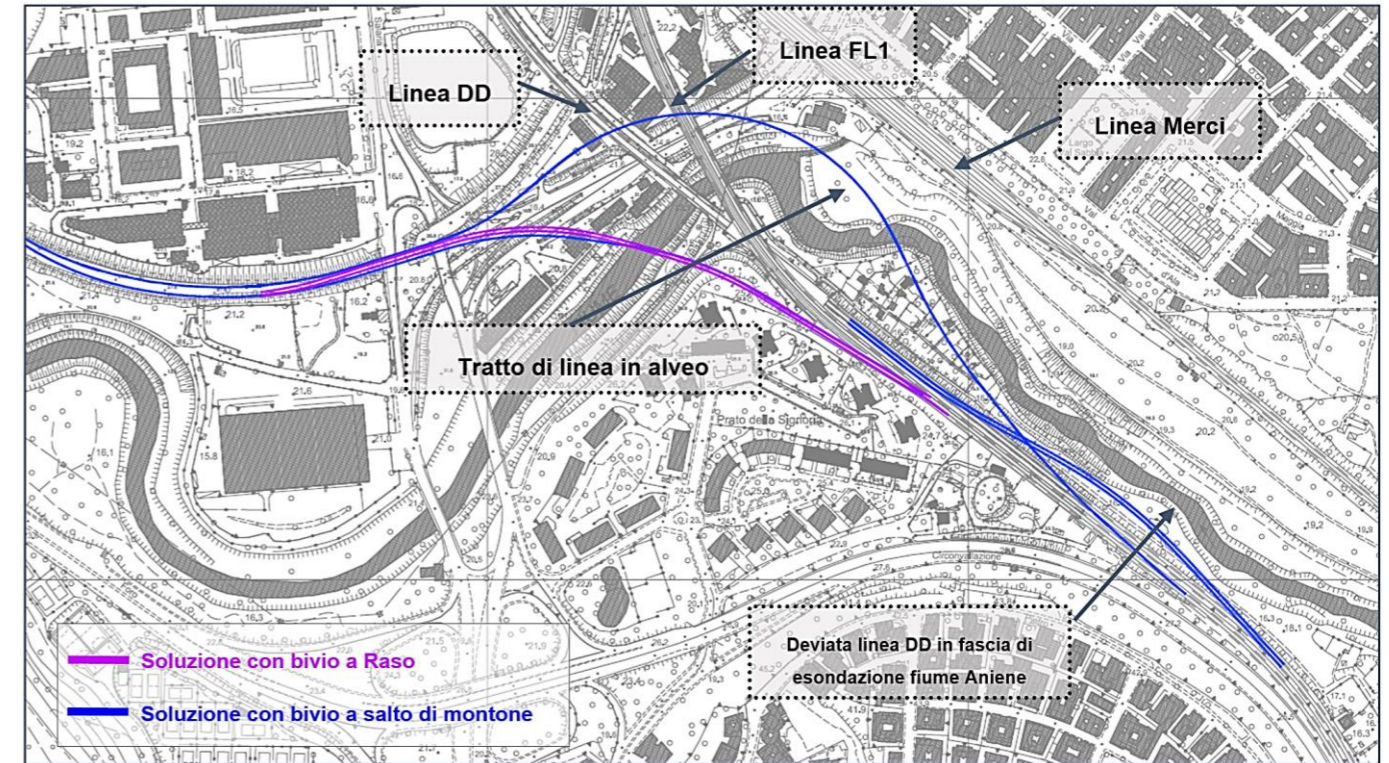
Planimetria alternative di progetto dell'innesto su linea FL1
